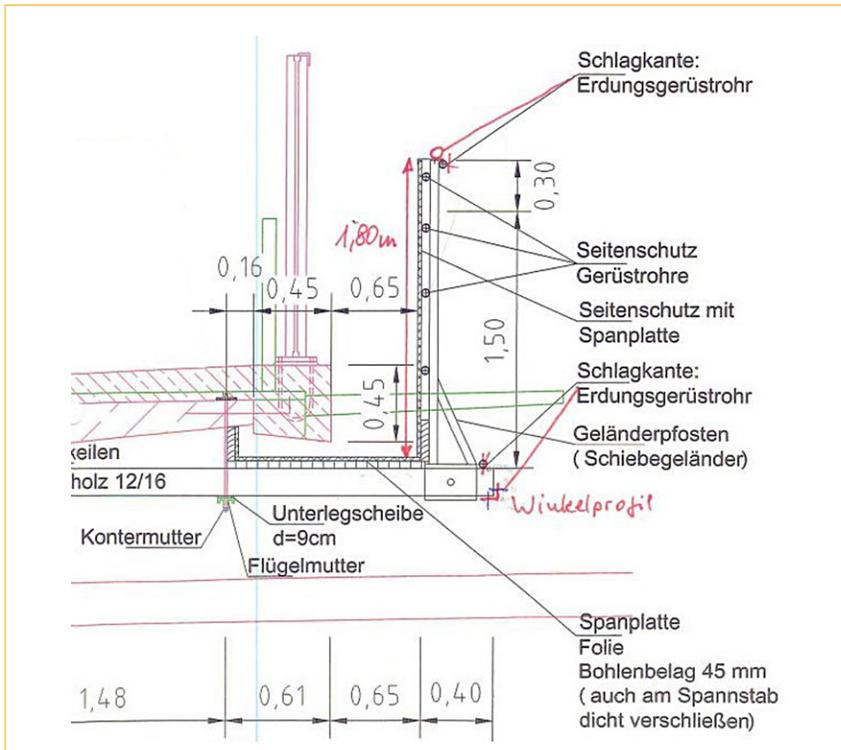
Traggerüst: Detailzeichnung mit handschriftlichen Änderungen des Prüfstatikers, o. M.
